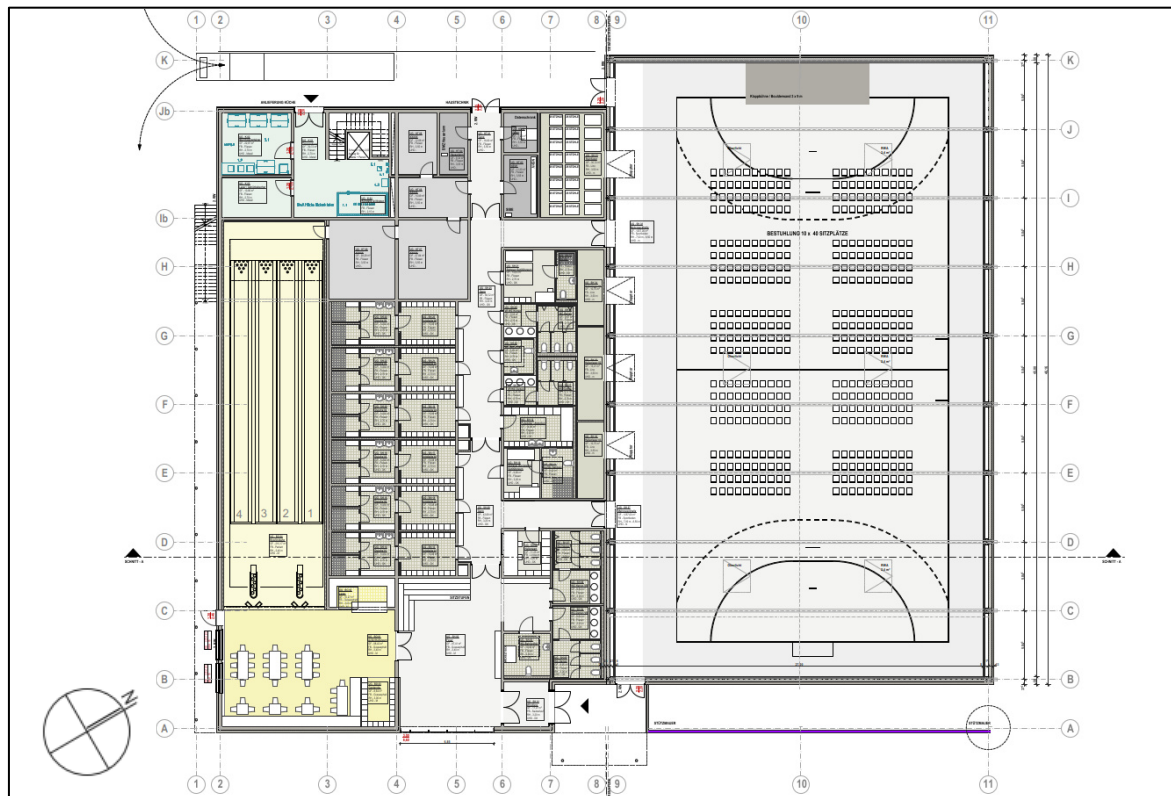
UG-Grundriss der Mehrzweckhalle (Weise Planungsgesellschaft mbH)
